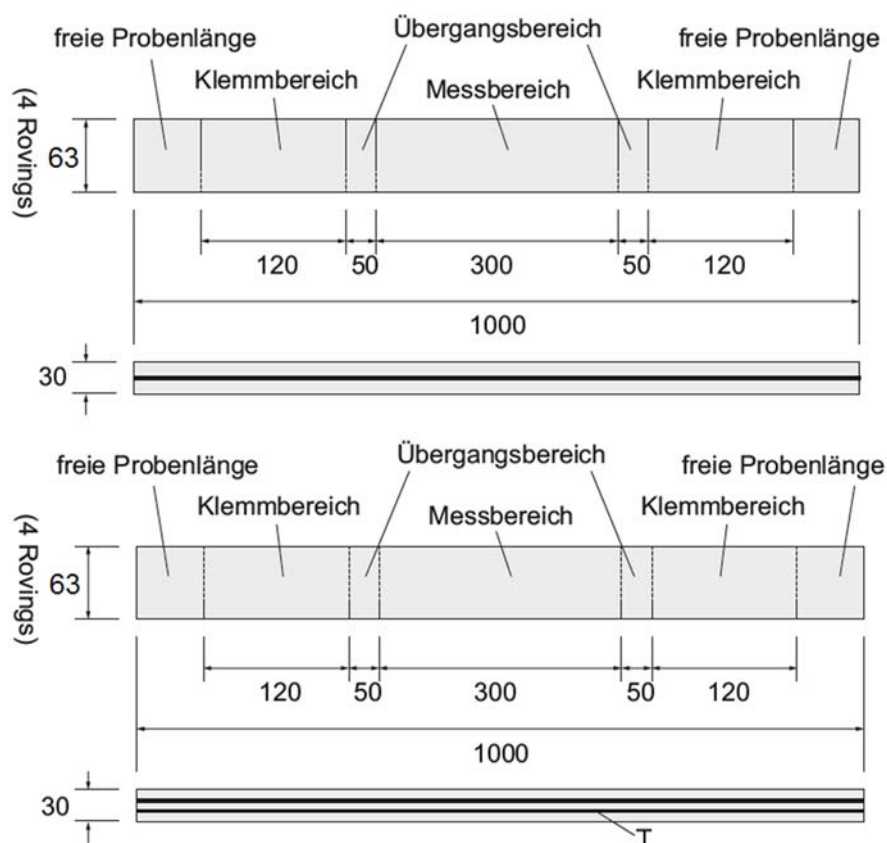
Aufbau eines Dehnkörpers mit einer Textillage (oben) und zwei Lagen (unten)
